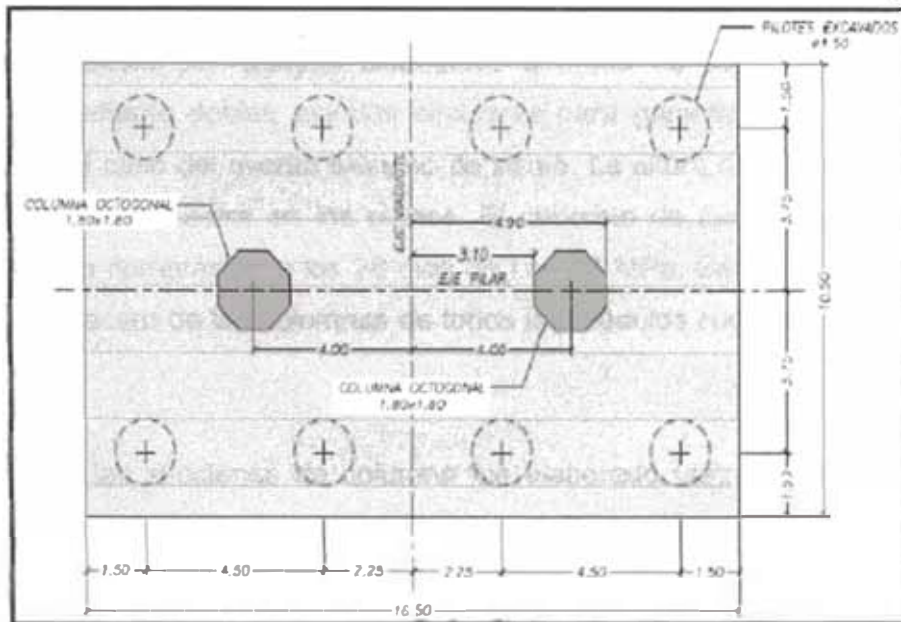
Planta de la Cimentación Típica de las zapatas- Ejes S49, S50 & S51
